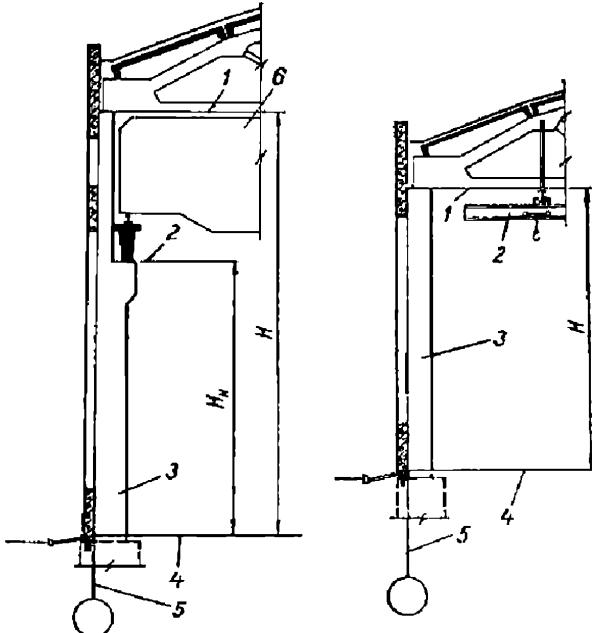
Высота зданий, оборудованных мостовыми кранами:
